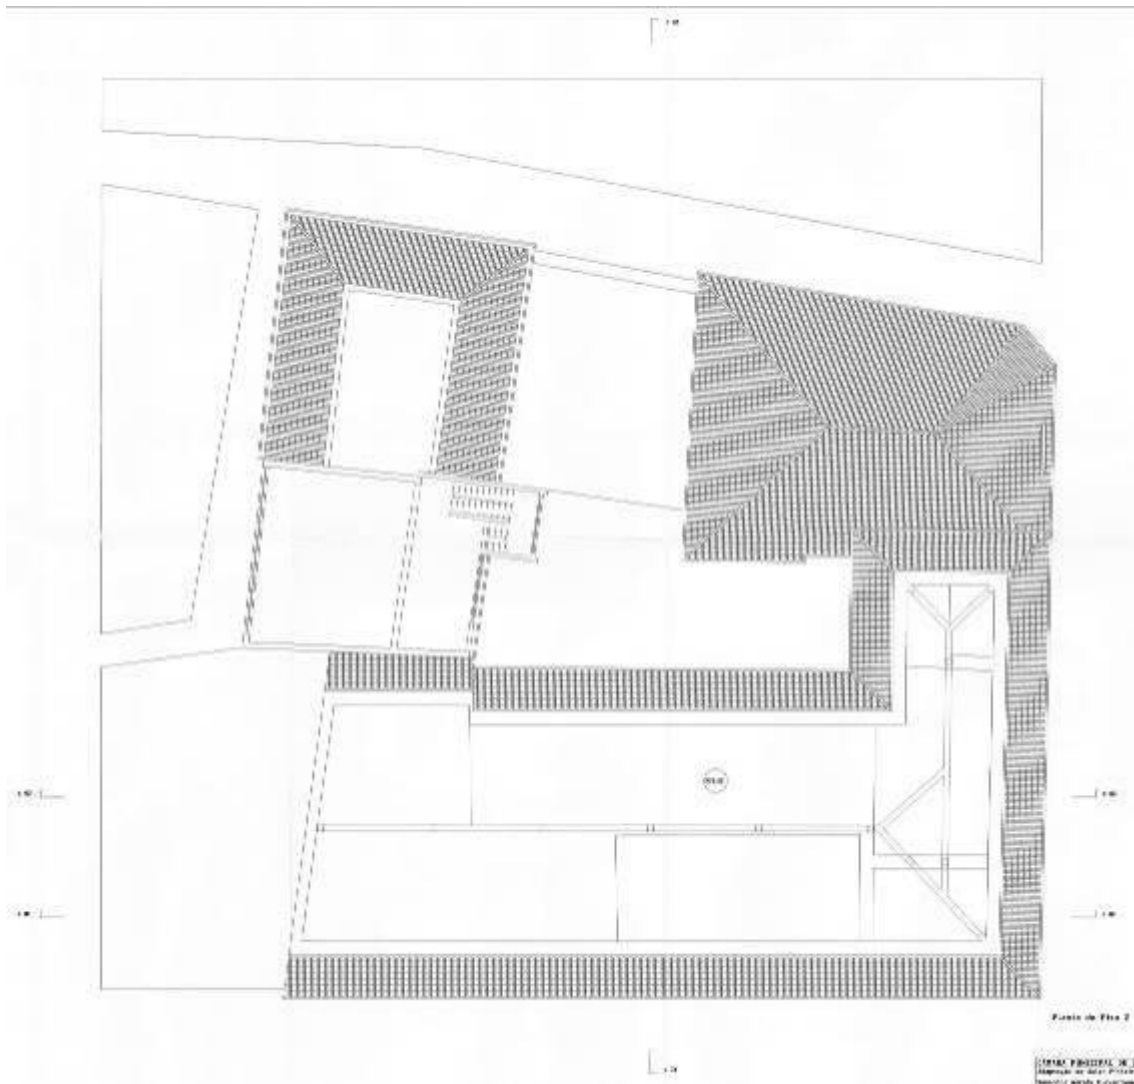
Planta do Piso 2. Escala 1/100. Projeto abril 2007. L.4. Câmara Municipal de Lamego. Adaptação do Solar Pinheiro de Aragão a Biblioteca Municipal. Execução. Desenhos Gerais, (Levantamento)<sup>99</sup>.
